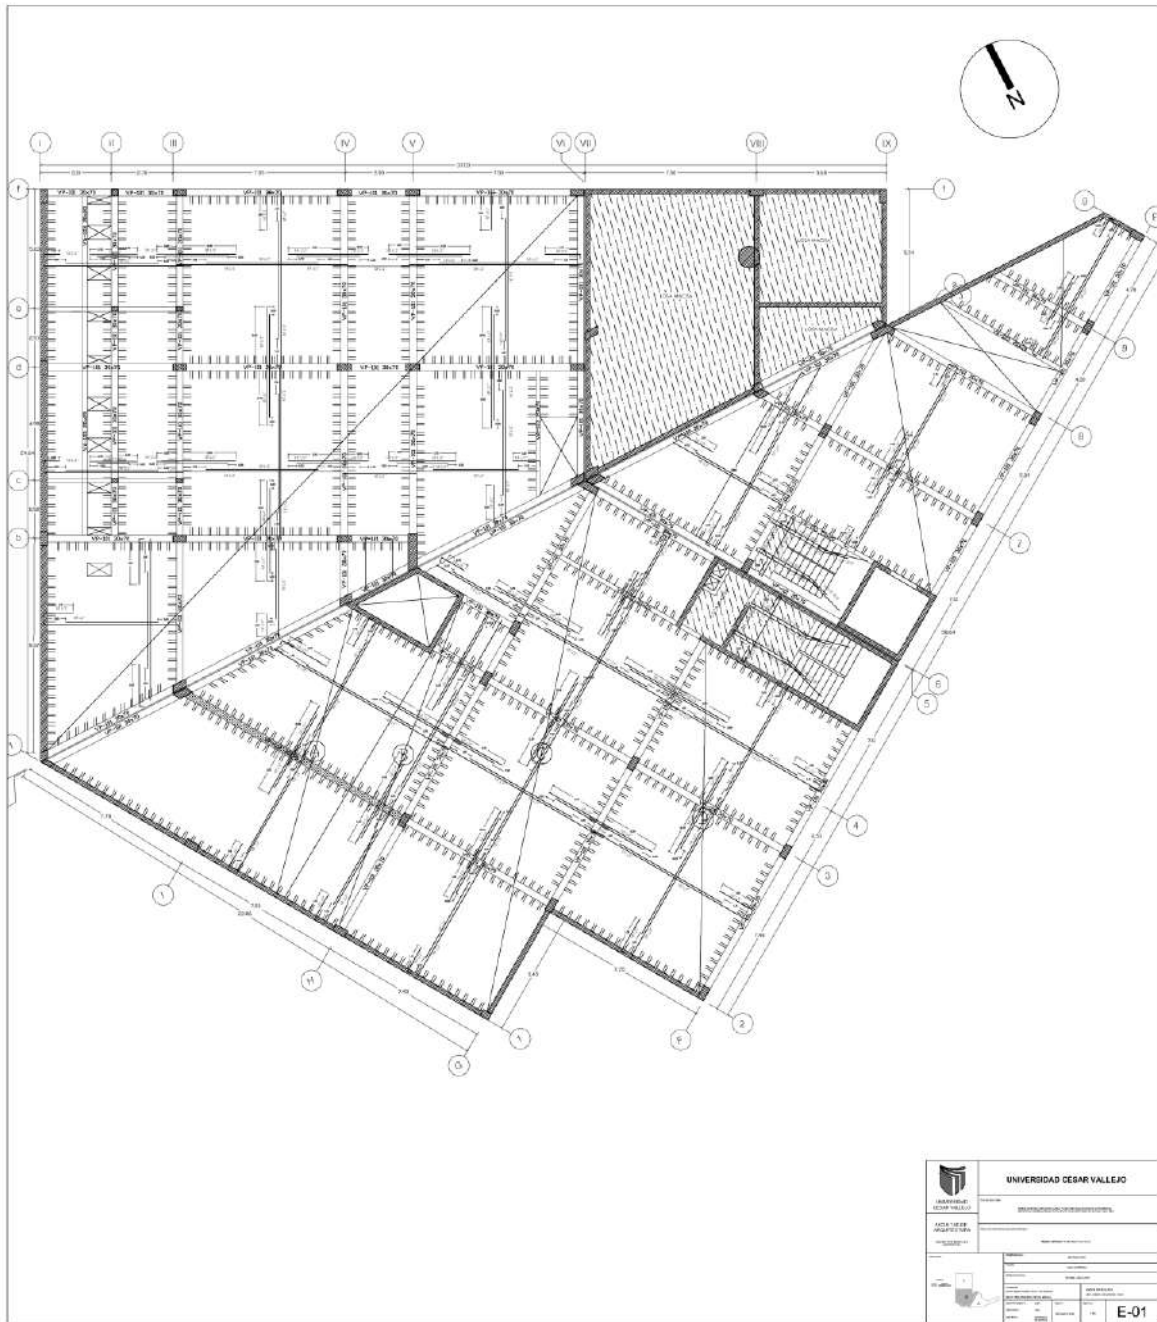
Aligerado - Sótano sector B - ESTRUCTURAS
